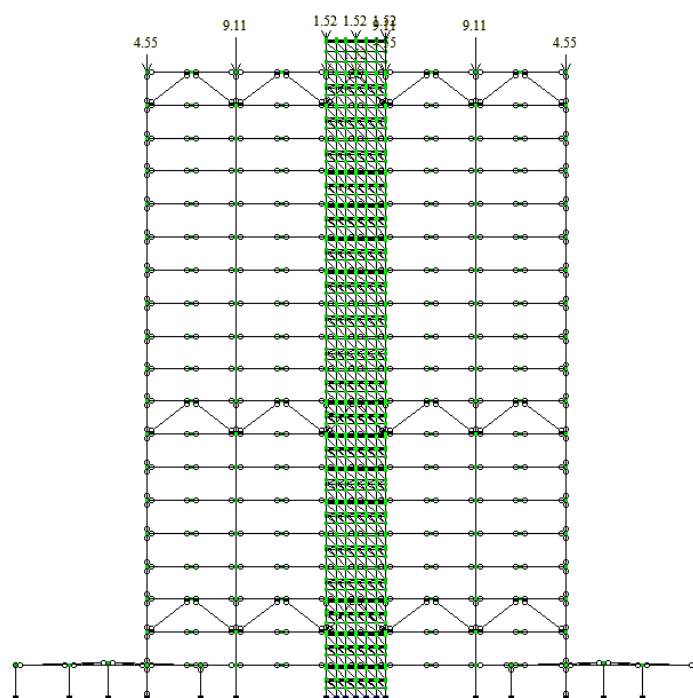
, 11.11. и 11.12. Вес перекрытия + коммуникации (поперечный разрез)
